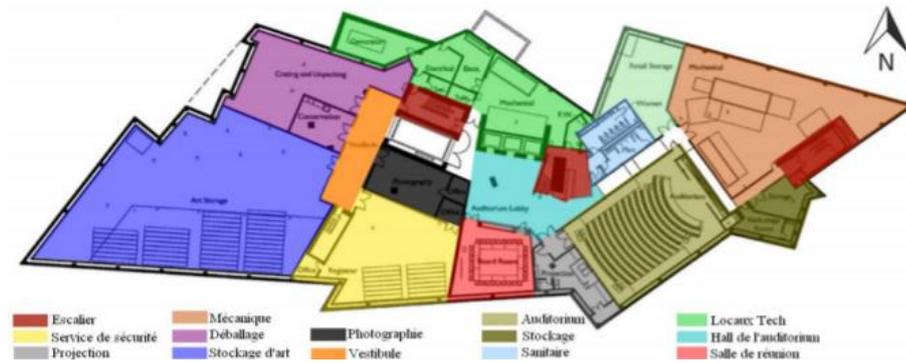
Plan sous-sol. Source : www.archdaily.com, édité par l'auteur
